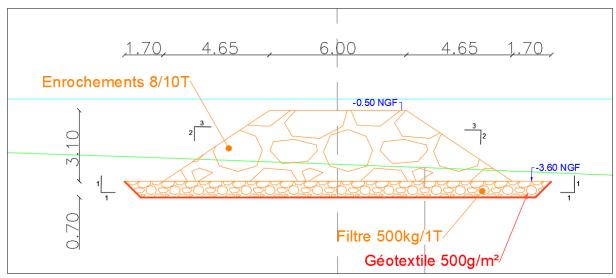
Coupe type selon A-A' du brise lame en enrochement sur la plage du Centre-Ville
